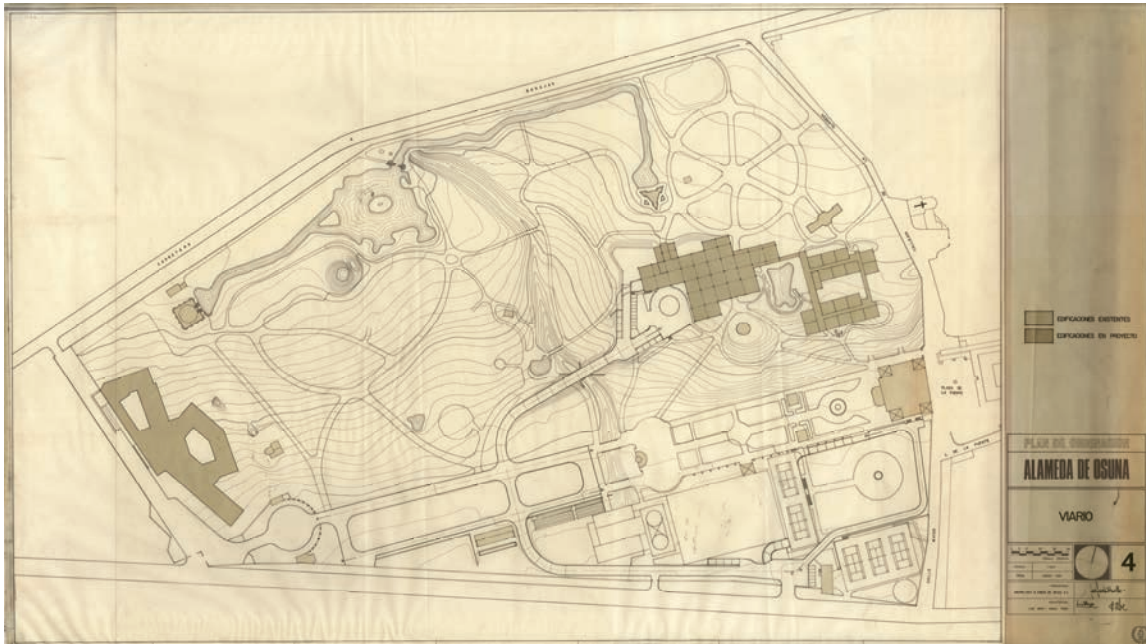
Planta general. Fondo Luis Moya de la biblioteca de la ETSAM.
